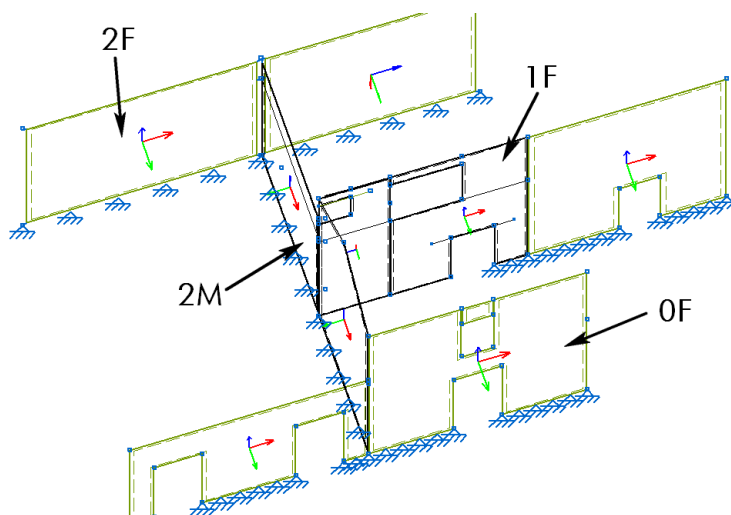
Modelo de muros para cálculo de cargas que se transmiten a la estructura de planta alta
